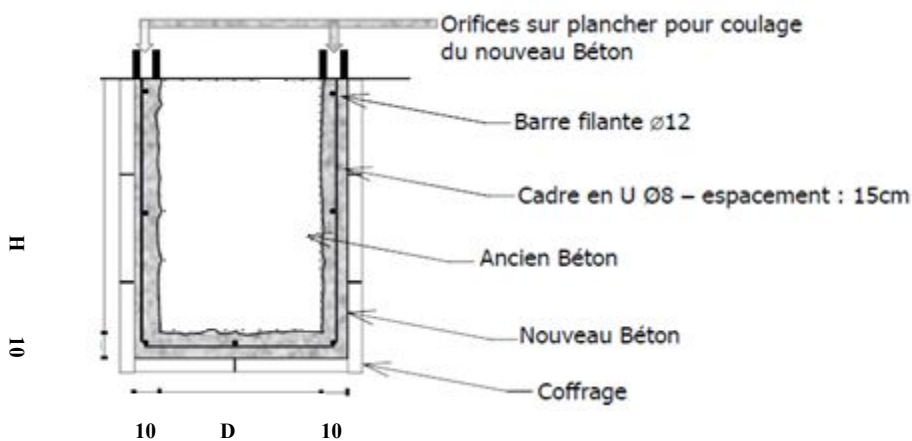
Ferrailage et coffrage des Poutres et Poutrelles
